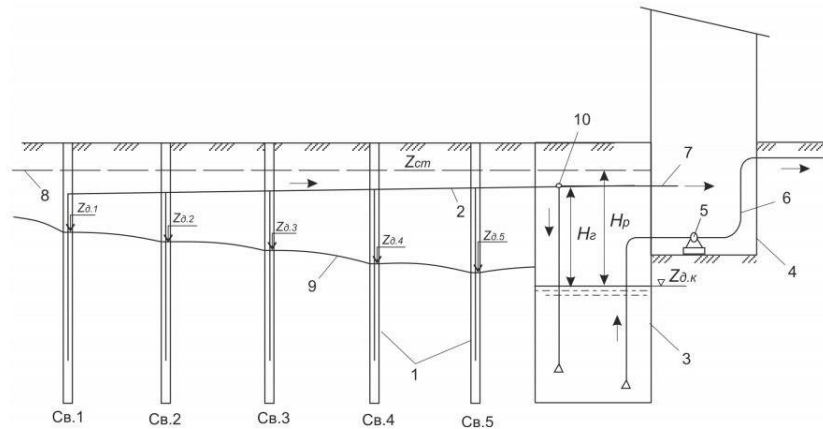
Розрахункова схема збору води з 5 взаємодійних свердловин і транспортування її гілкою 1 сифонного водоводу до збірного колодязя ДК1:
